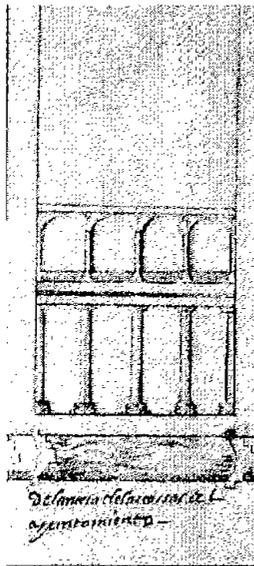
Vista de las Casas del Cabildo en plano de 1596.
